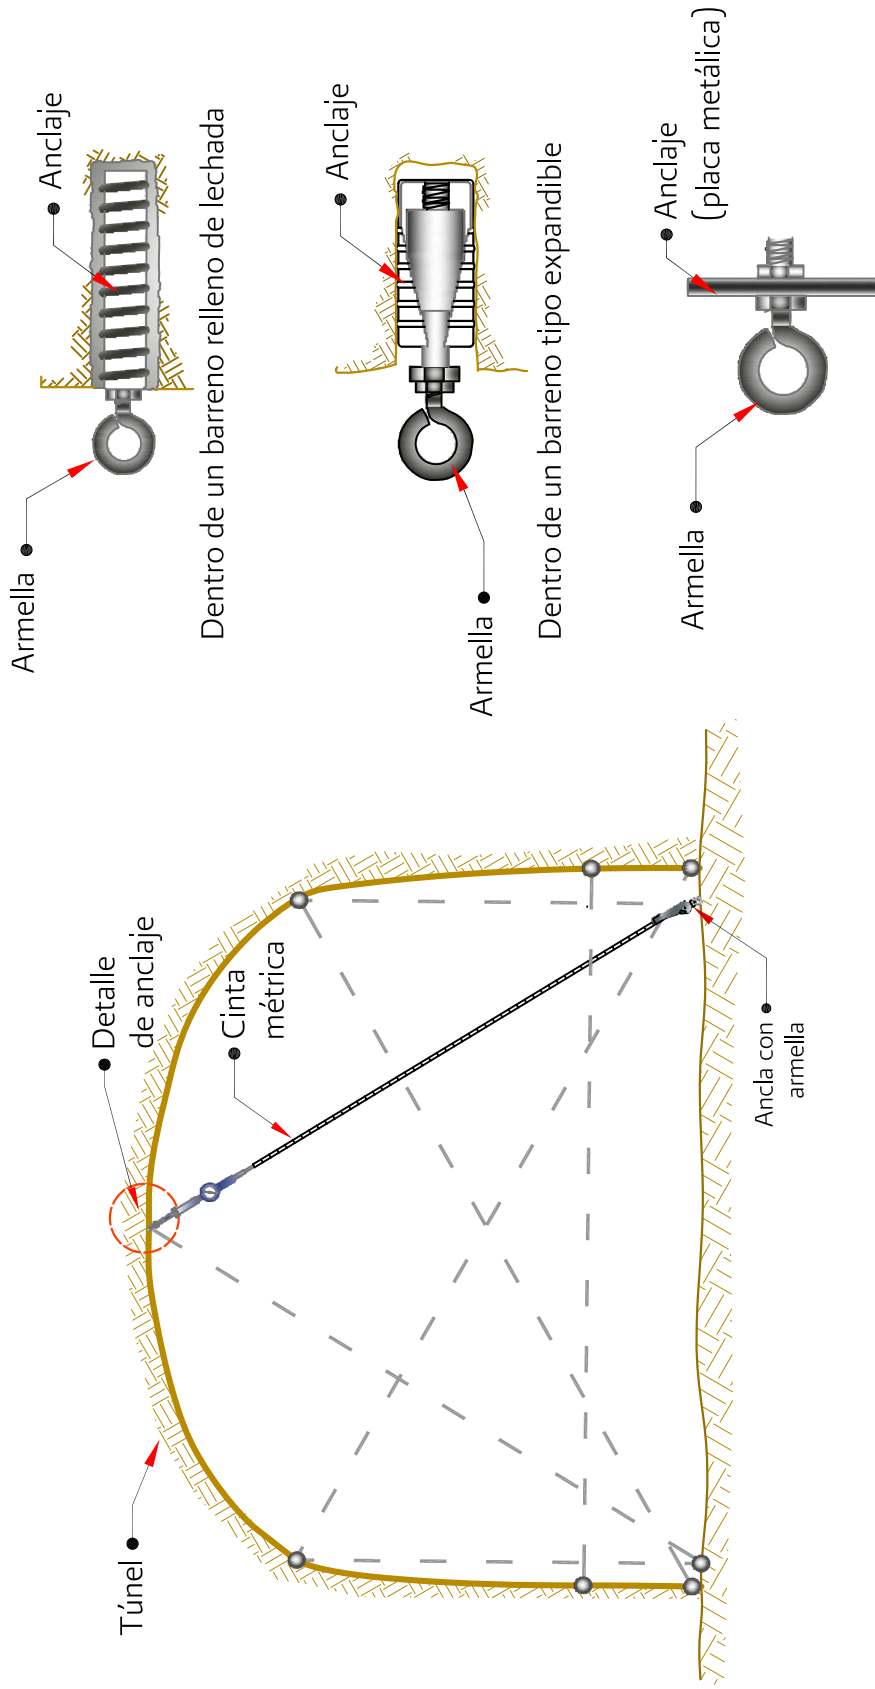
Ubicaciones propuestas para instalar un extensómetro de convergencia
